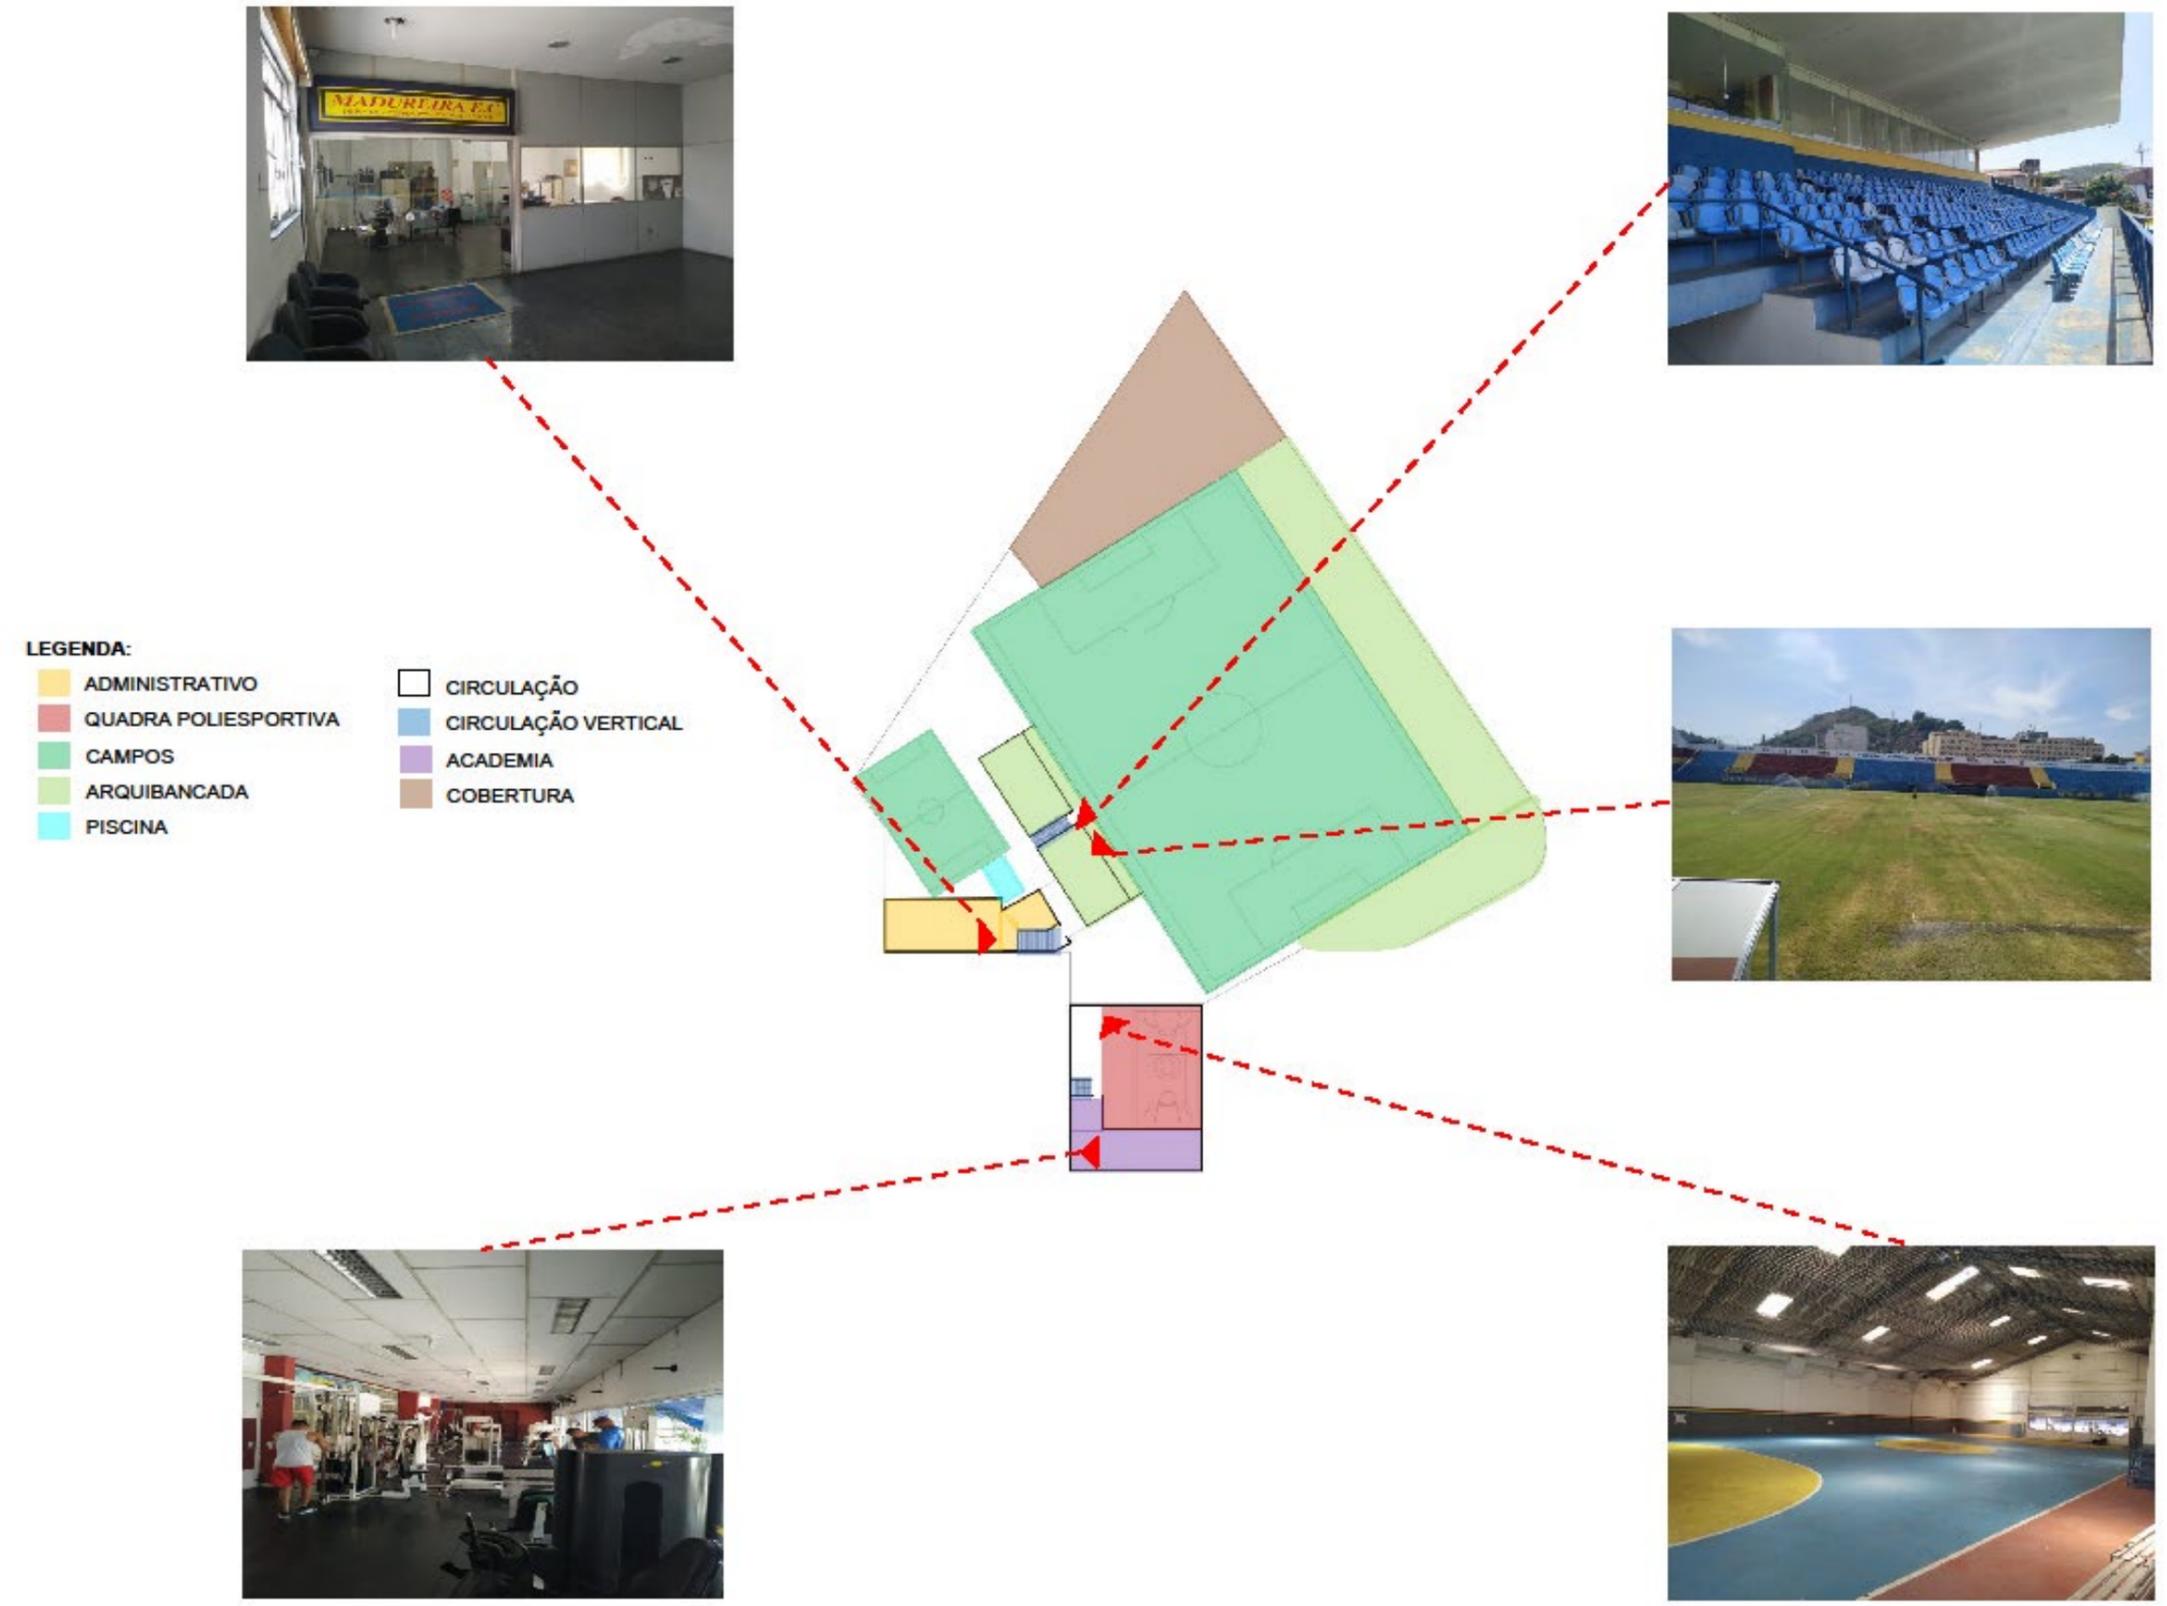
Localização das estruturas do piso do 2º pavimento do Madureira.
